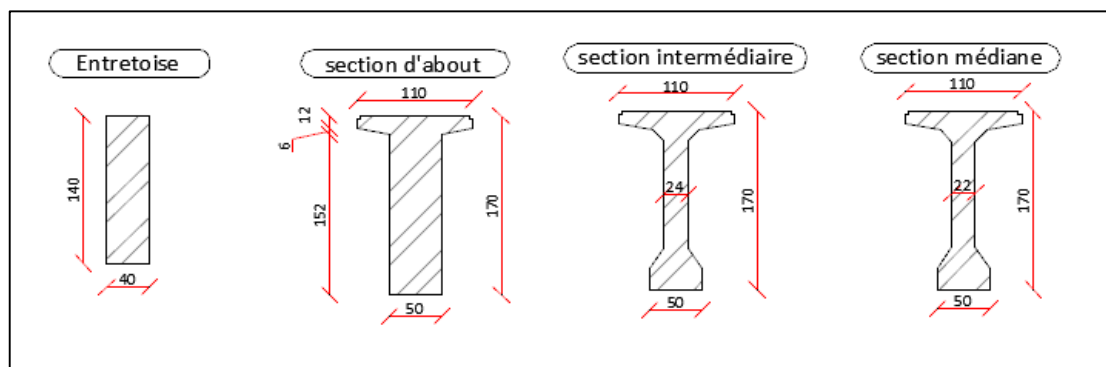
les différentes sections transversales des poutres de la variante (1)
